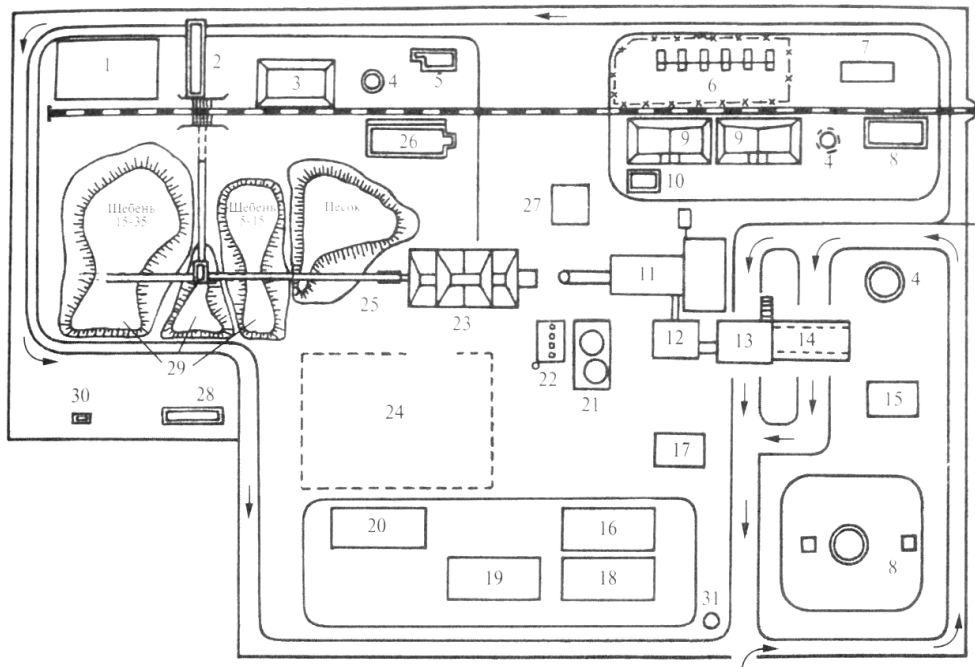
Генеральный план АБЗ: 1 – склад топлива и масел; 2 – разгрузочная площадка; 3 – склад твердого топлива; 4 – пожарный резервуар; 5 – парокотельная и душ; 6,9 – битумохранилище; 7 – песок; 8 – пожарный сарай; 10 – установка для обезвоживания и нагрева битума; 11 – сушильный барабан; 12 – дозирочно-сортировочные агрегаты; 13 – смесительный агрегат; 14 – накопительный бункер; 15 – площадка для машин потребителей смеси; 16 – место для курения и отдыха; 17 – лаборатория; 18 – гардероб; 19 – ремонтная мастерская; 20 – склады минеральных и запасных частей; 21 – расходные силосы минерального порошка; 22 – агрегат обеспыливания и удаления газов и дыма; 23 – агрегат грубого дозирования (агрегат питания); 24 – резервная площадка для минерального порошка; 25 – ленточный транспортер; 26 – цех приготовления минерального порошка; 27 – пульт управления АБЗ; 28 – умывальник и гардероб; 29 – склад минеральных материалов; 30 – туалет; 31 – охрана
